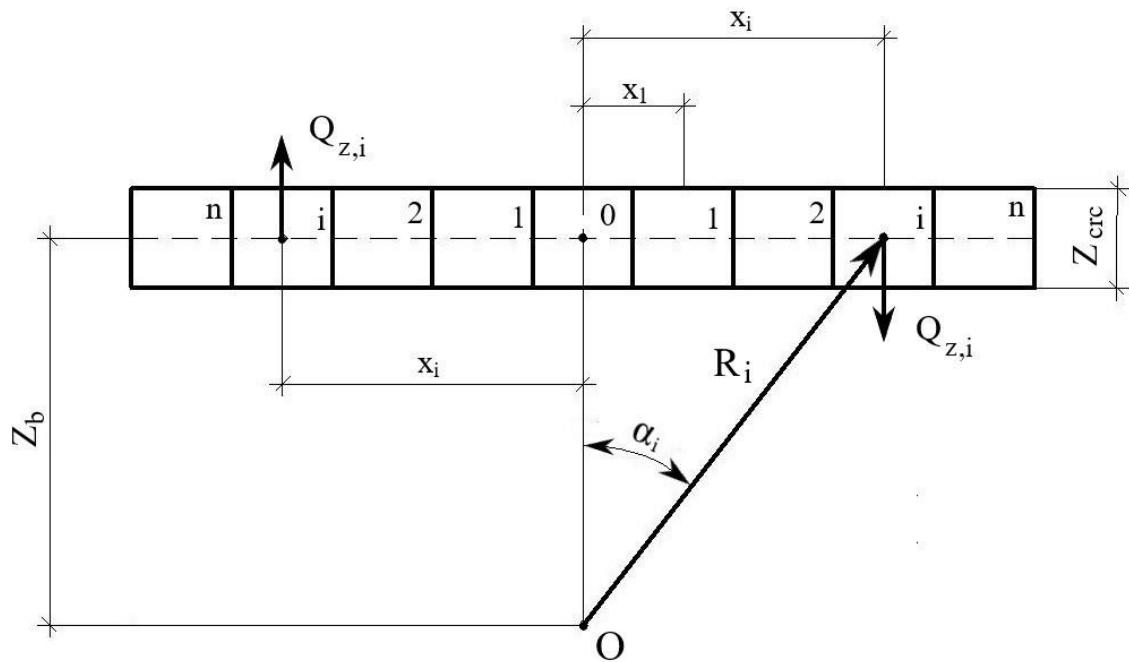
Схема деления сжатой зоны бетона по ширине элемента
